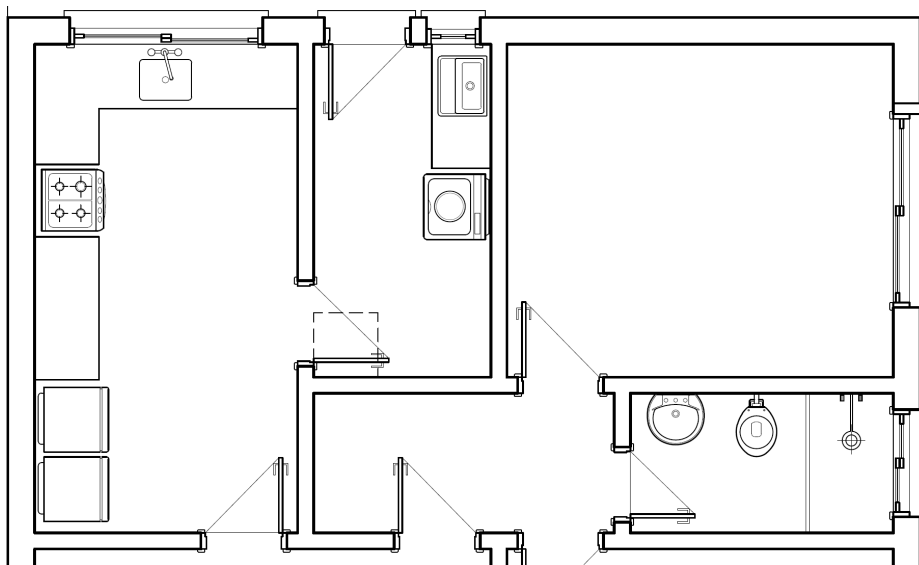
Etapas de representação da planta baixa: equipamentos fixos. Fonte: autor
